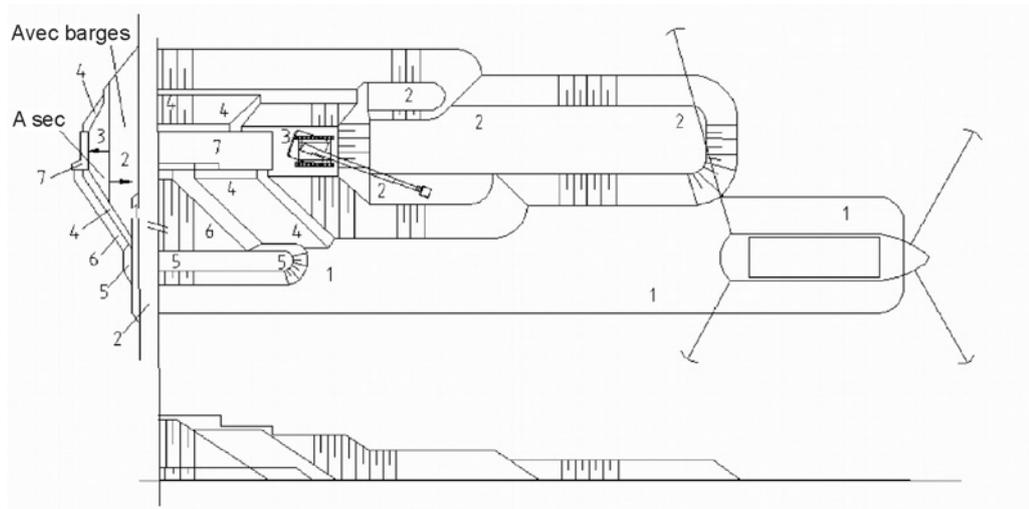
Vue en plan, de côté et coupe transversale d'un chantier de digue avec construction simultanée par moyen terrestre et nautique.
